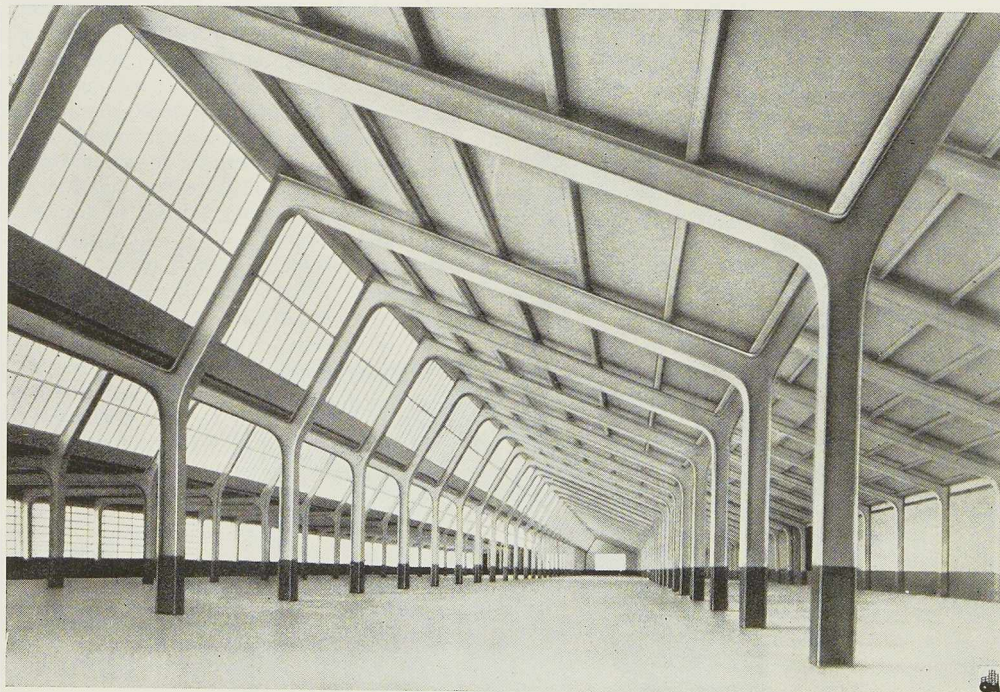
Une nouvelle charpente soudée pour bâtiments industriels a été dernièrement réalisée aux Etats-Unis, par la Austin Company de Cleveland (Ohio). Cette charpente, remarquable par sa simplicité, est constituée de profils à larges ailes soudés. Tout en ayant tous les avantages des toitures en shed, ce type de charpentes permet une meilleure utilisation des locaux, grâce à la suppression des tirants.
